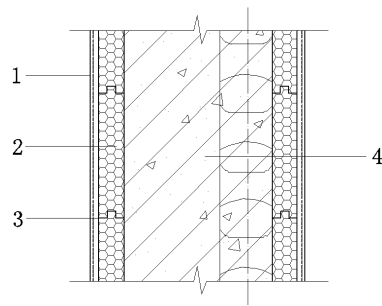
扶墙柱与墙体连接组合构造（垂直剖面）
